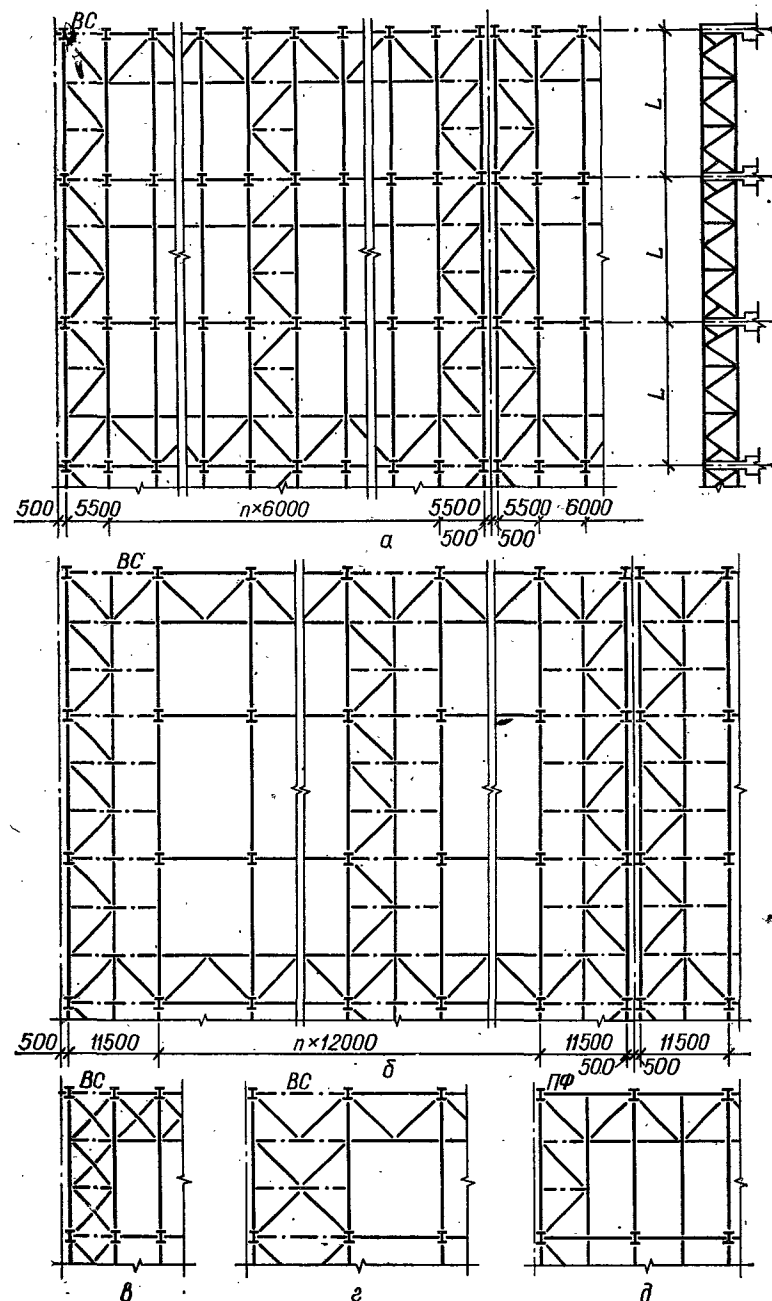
Схемы расположения элементов покрытия в уровне нижних поясов ферм: а, б — при шаге ферм соответственно 6 и 12 м; в, г — с крестовой связевой решеткой при шаге ферм соответственно 6 и 12 м; д — при наличии подстропильных ферм (BC — вертикальные связи; ПФ — подстропильные фермы).
